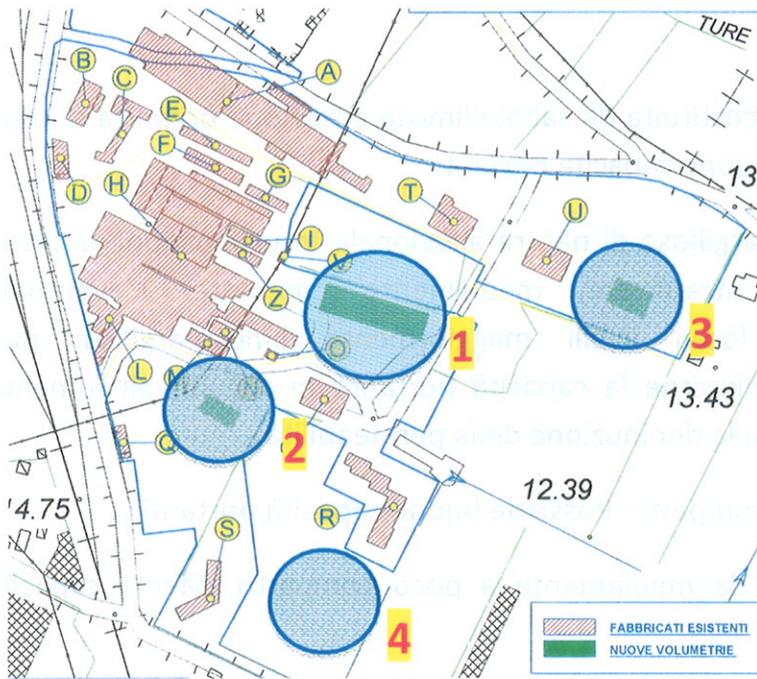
Suddivisione del lotto nei 4 siti principali di intervento
